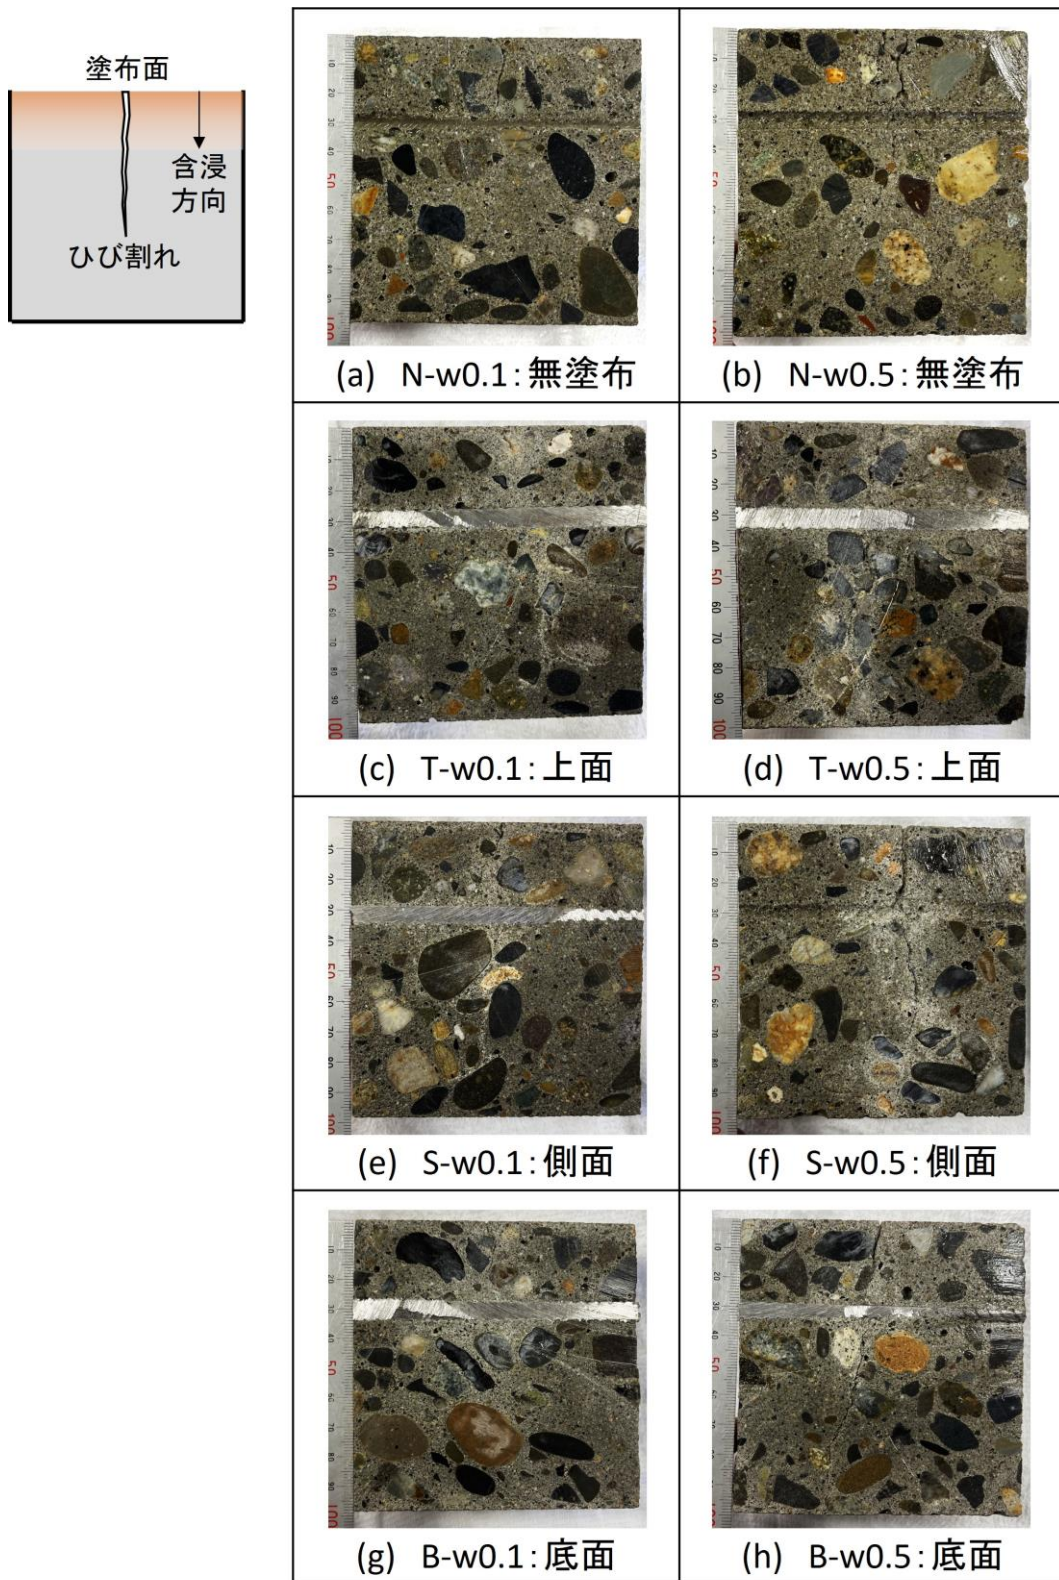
ひび割れがない供試体の含浸深さ測定時の断面
